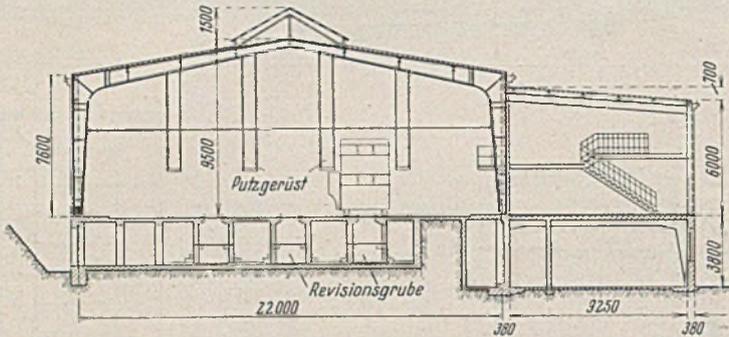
Halle I. Querschnitt an den Putzgerüsten.
